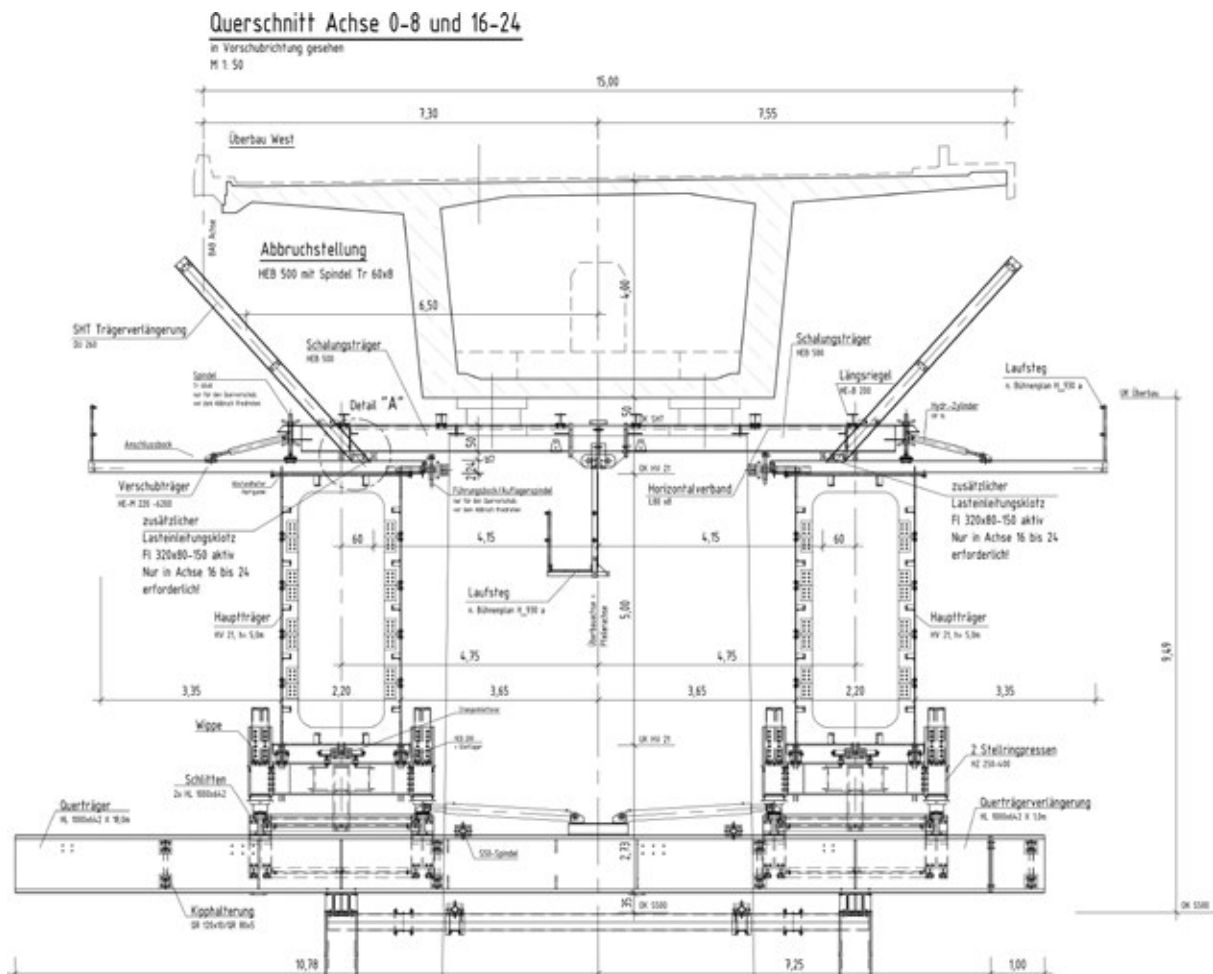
Brückenquerschnitt mit Abbruchwanne und Traggerüst
